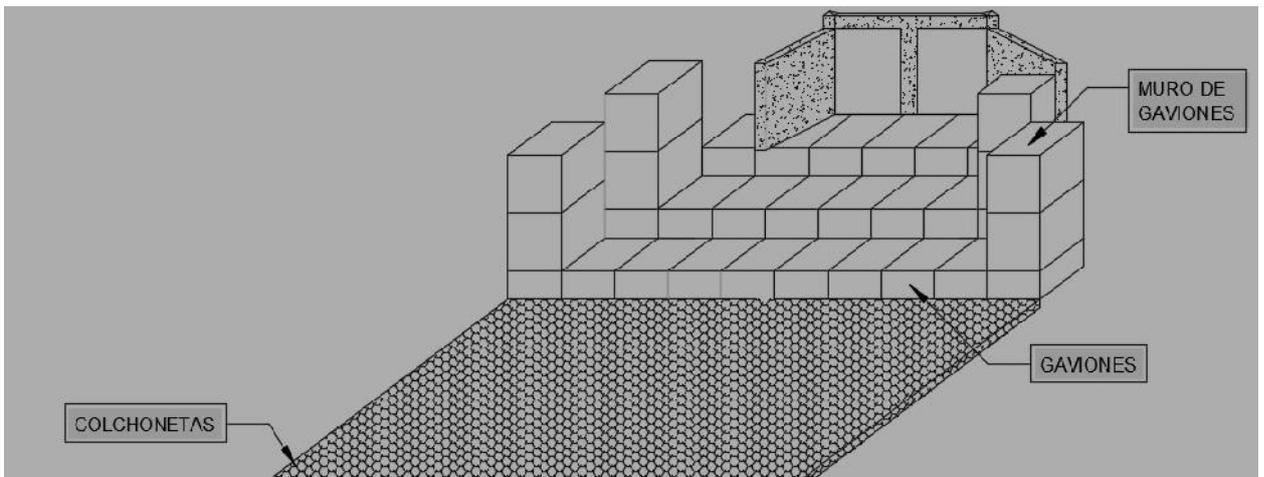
Esquema 3D del Tramo Final del Canal N° 3
